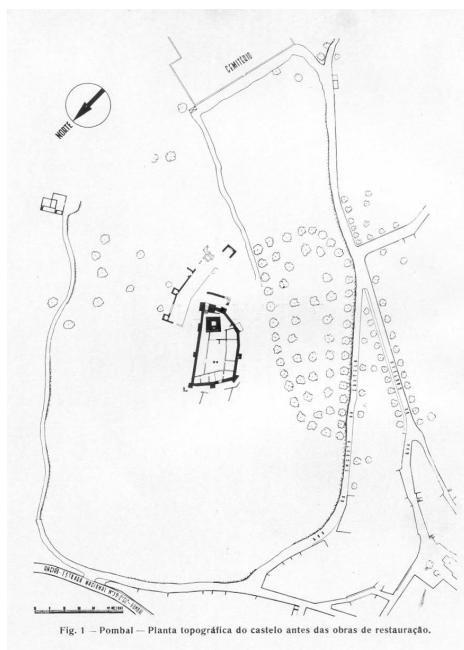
Planta do Castelo de Pombal antes do restauro. 1950
